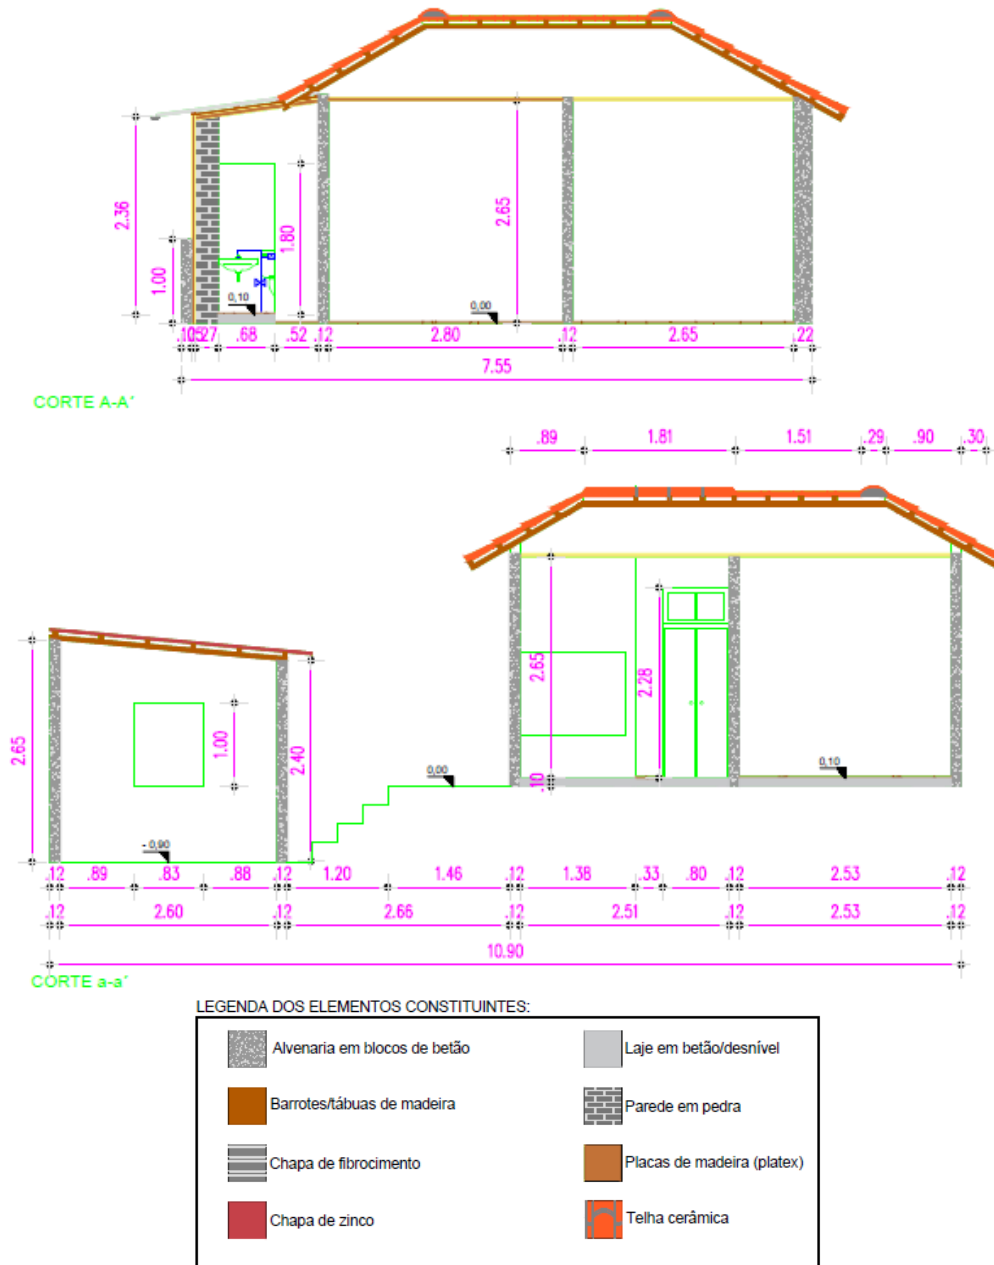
Corte longitudinal A-A' e transversal a-a'
